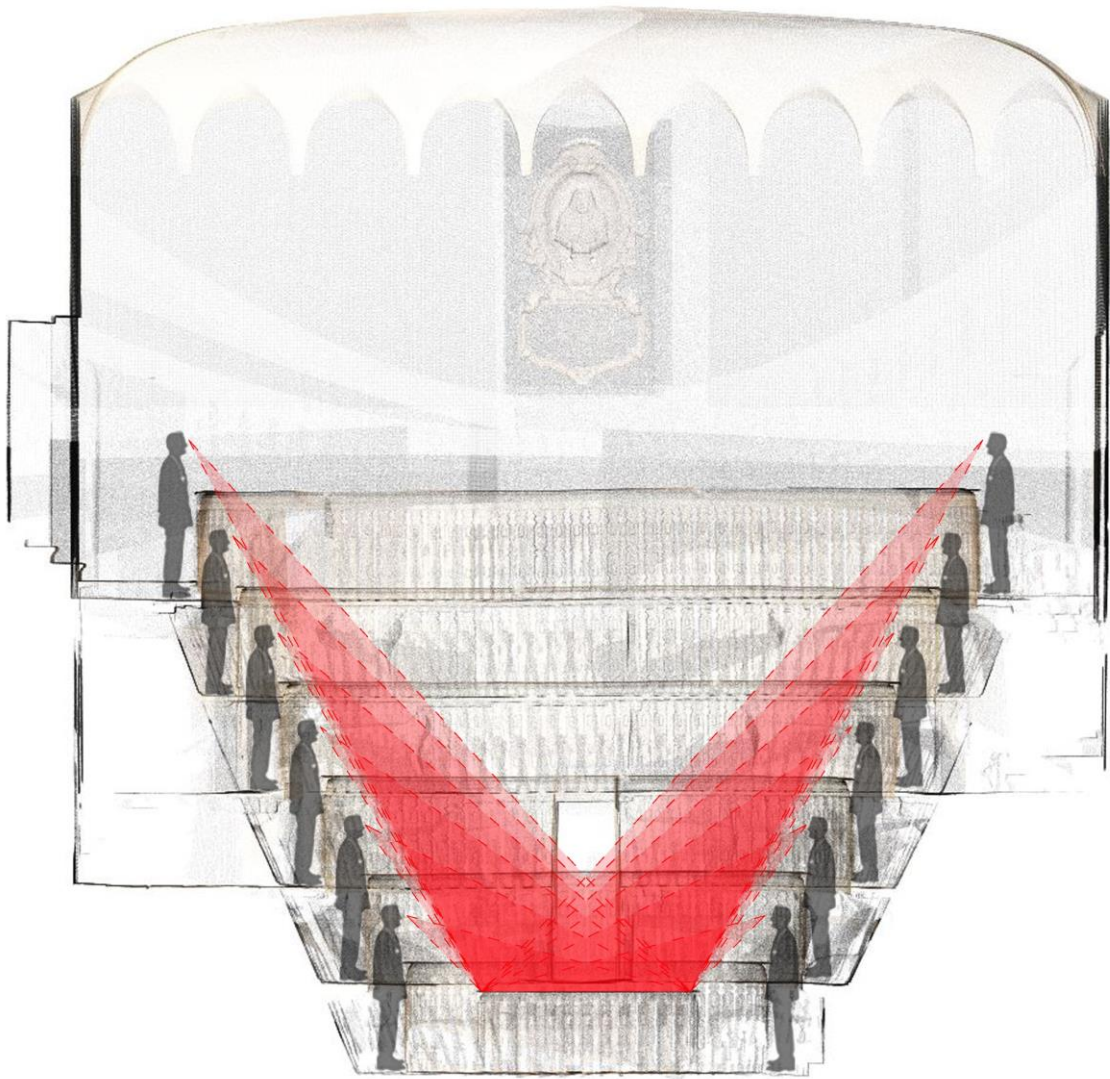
Sezione longitudinale in cui compare lo schema visivo degli spettatori nel tavolo settorio
